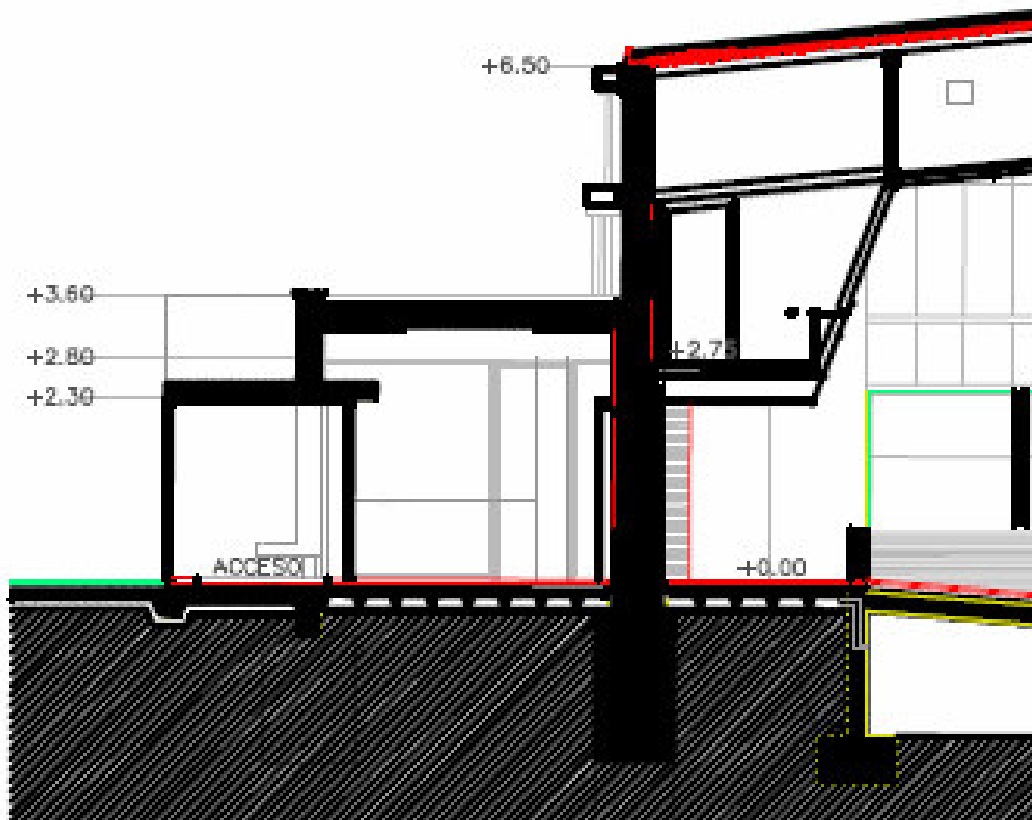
(b) Detalle del alzado anterior en el que se aprecia la altura de varios de los muros.
